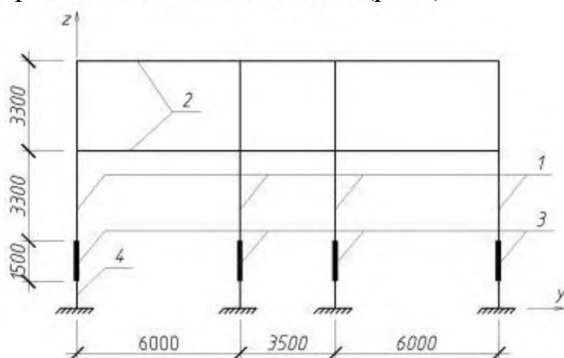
Расчетная схема поперечной рамы: 1 – колонны; 2 – ригель; 3 – фундамент; 4 – стержень, моделирующий основание
